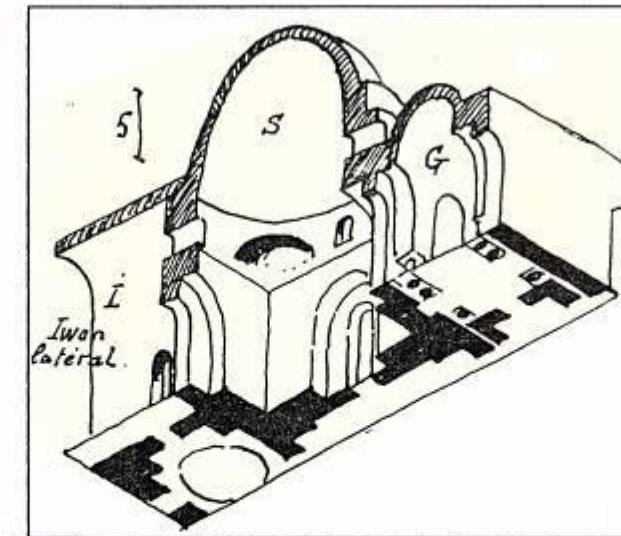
Détails constructifs de la salle centrale du palais de Sarwistan (CHOISY, 10).
